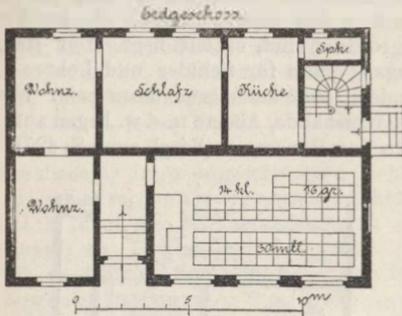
Erdgeschossgrundriß einer preußischen einklassigen Landschule.
